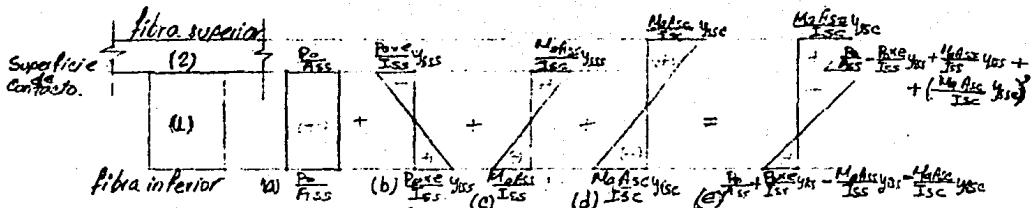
Esfuerzos actuantes sección A-A en c.s. de secc. compuesta. (1) Sección simple; (2) firme colado en sitio.
